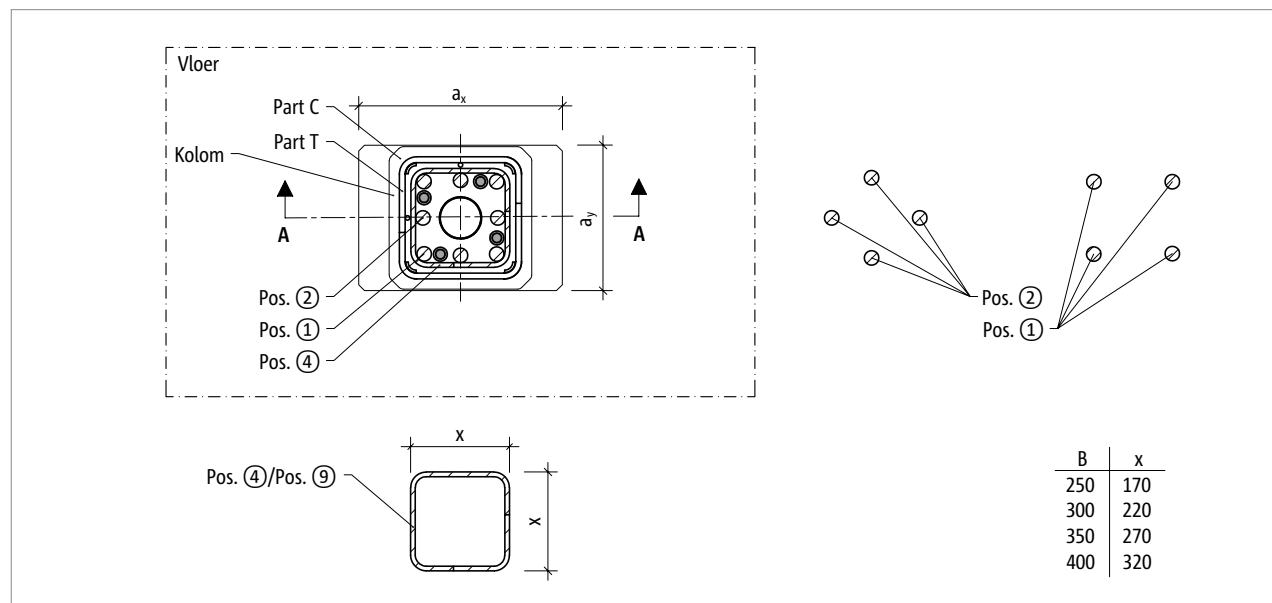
Schöck Sconnex® type P: Bijlegwapening in de kolomdoorsnede
